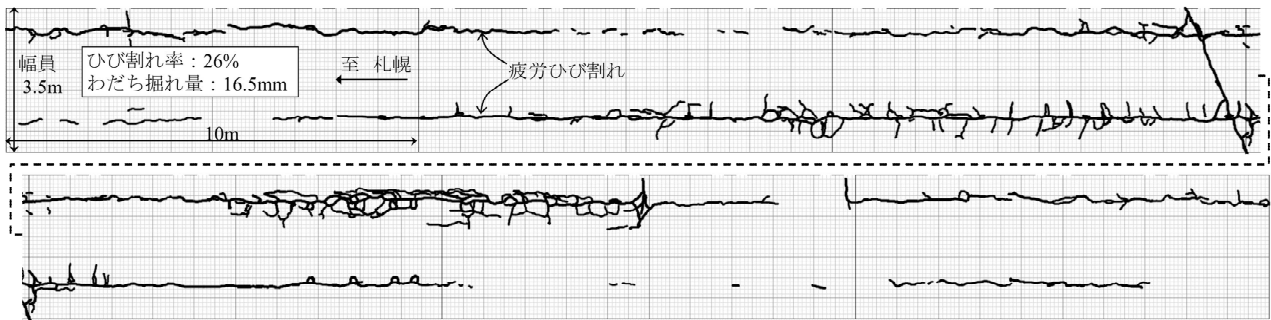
補修前の路面の疲労ひび割れ状況(幅員3.5m、延長60m区間)
